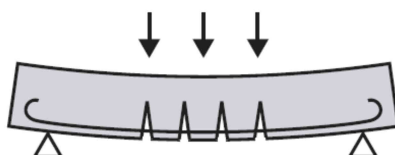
Viga de betão armado sob carga (Corven e Moreton 2004).
